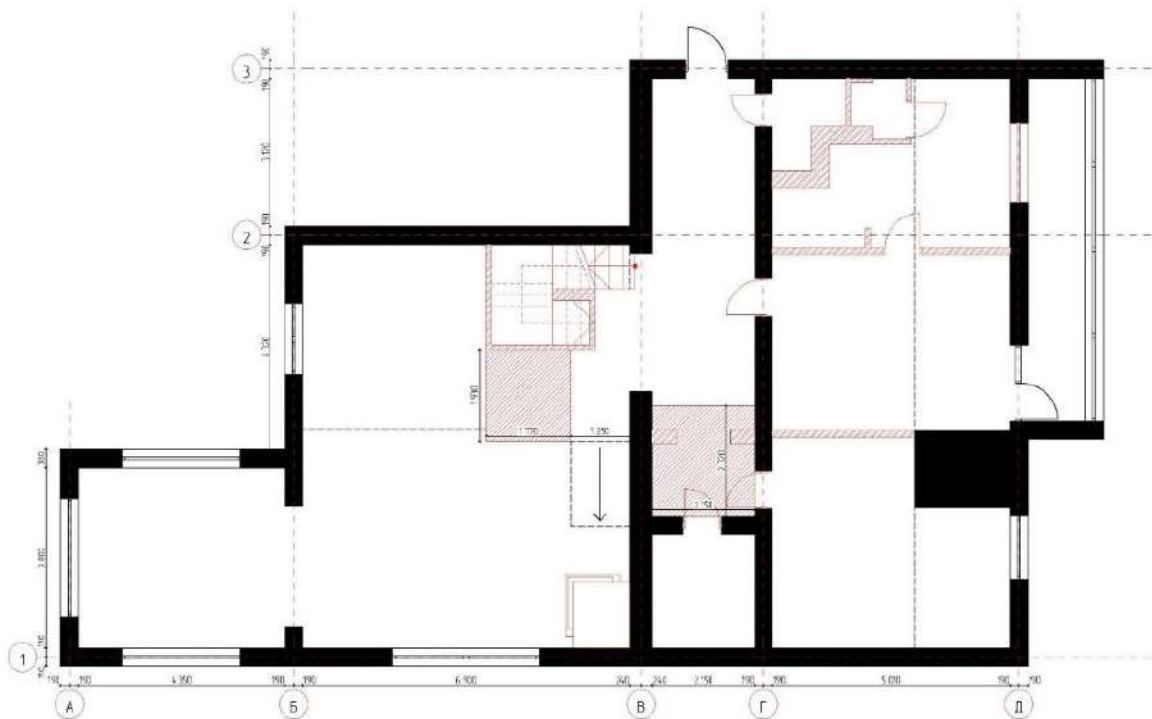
План демонтажу 1-го поверху (авторське креслення).
